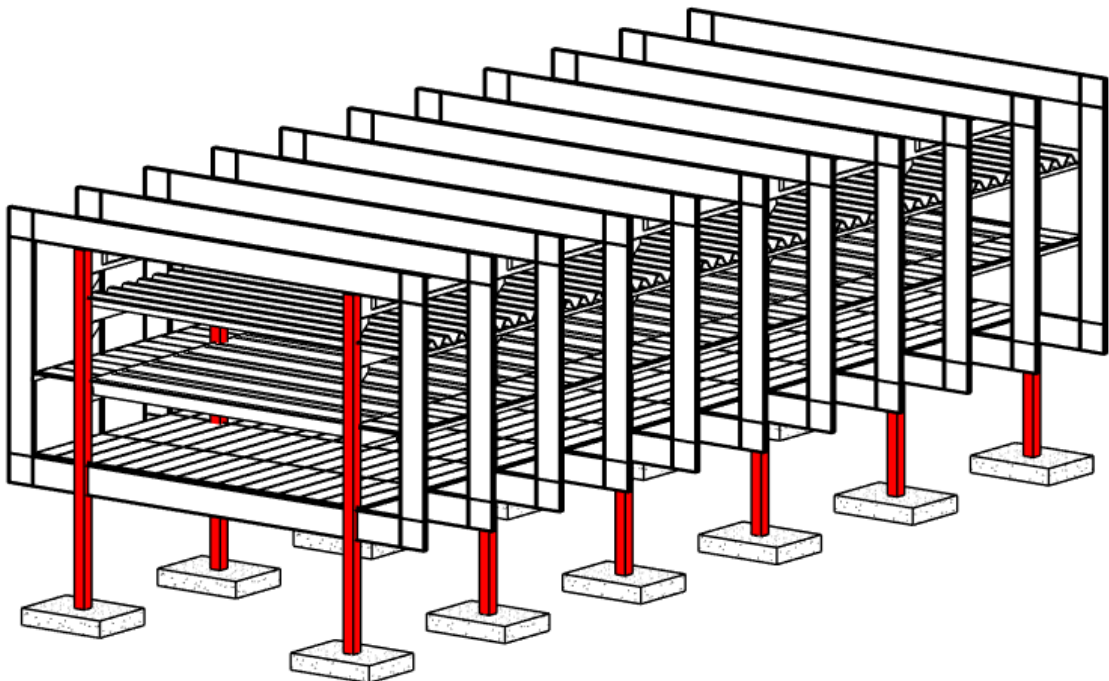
Ubicación de las columnas de hormigón armado. Fuente: Autor.
